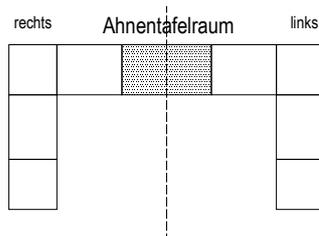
Grundriss-Schema des u-förmigen Wohnhofs
